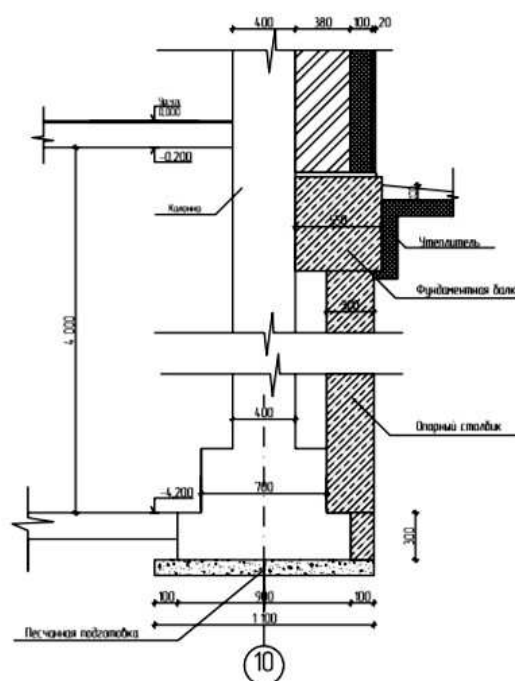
Сечение столбчатого фундамента Ф-3
